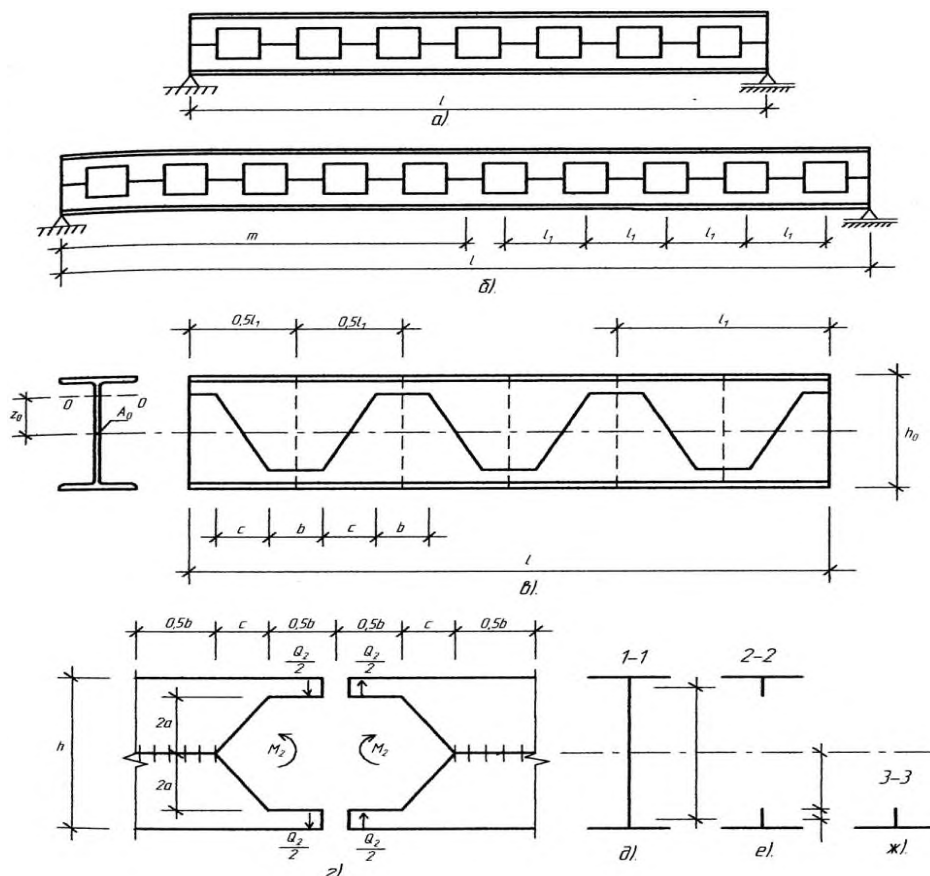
Розрахункова схема металевої конструкції балок, виготовлених із перфорованих двотаврів: *а, б* – конструктивні схеми балок; *в* – схема розкрою двотаврового перерізу; *г* – схема зусиль у розрахунковому перерізі балки; *д, е, ж* – схеми перерізів балки
